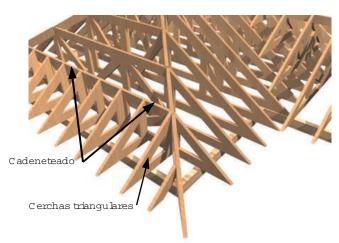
Cadenetas entre cerchas trapezoidales y cerchas triangulares, que además de ser el término del faldón generan el alero.
